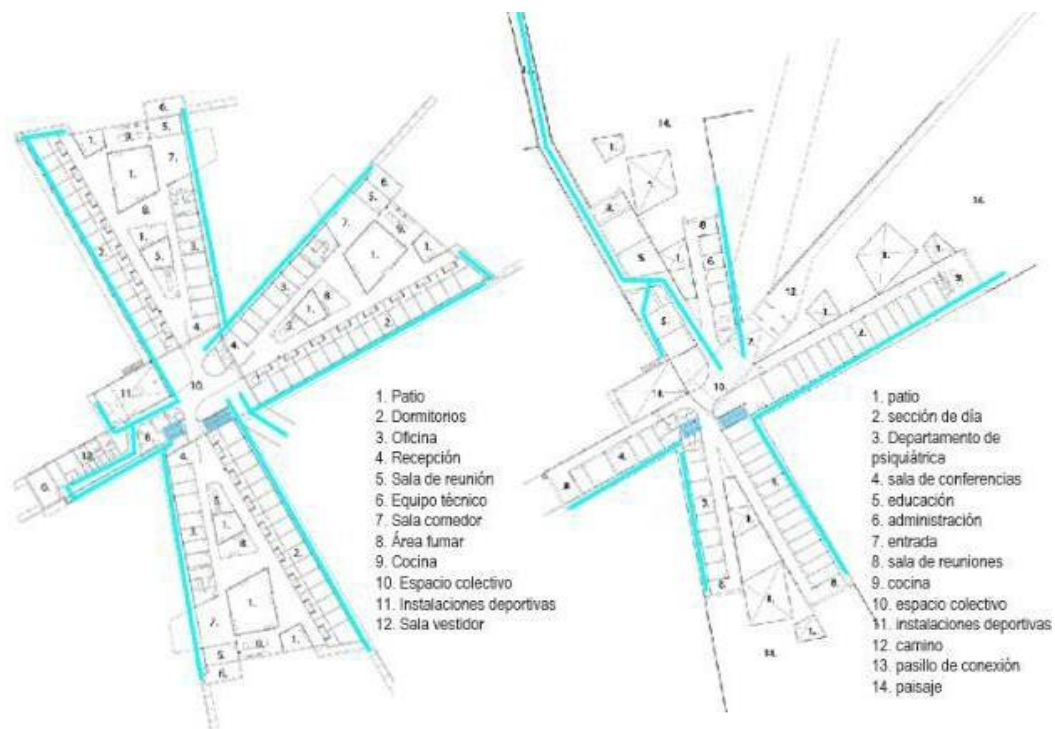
Clínica Psiquiátrica Ellsinore- plano en planta.
